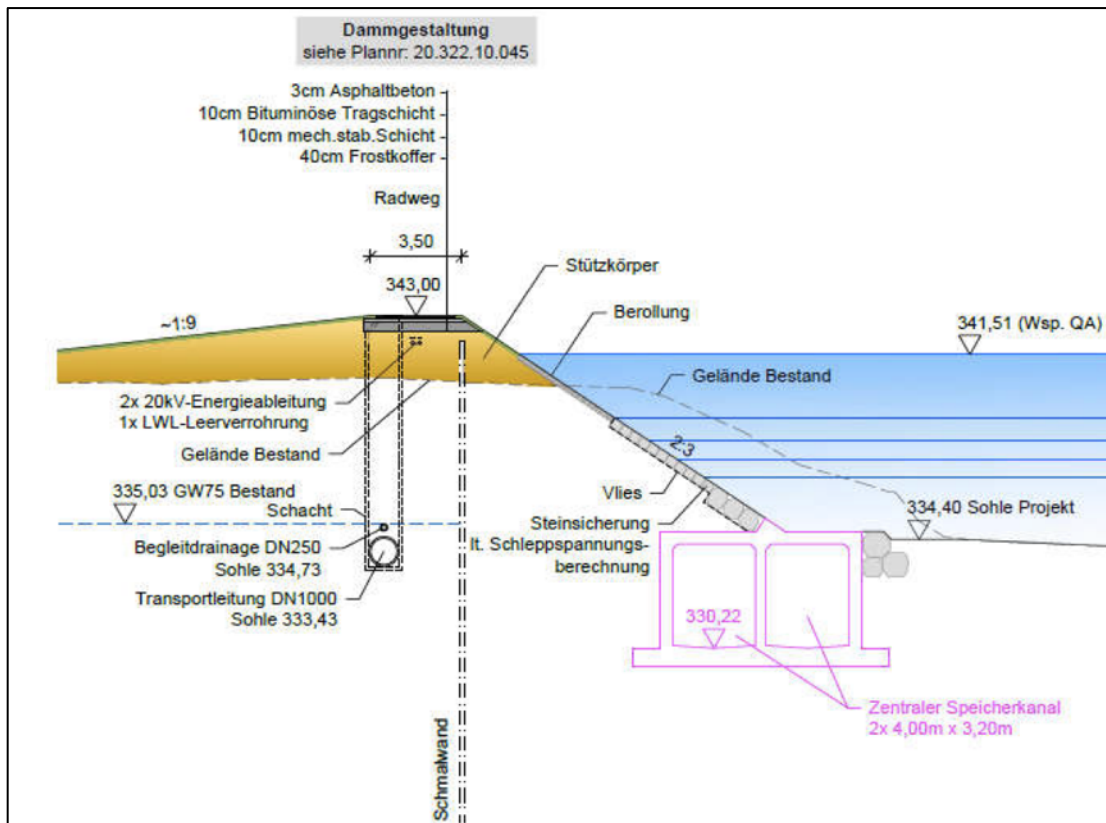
Dammkörper mit Schmalwand und Drainage [65]
